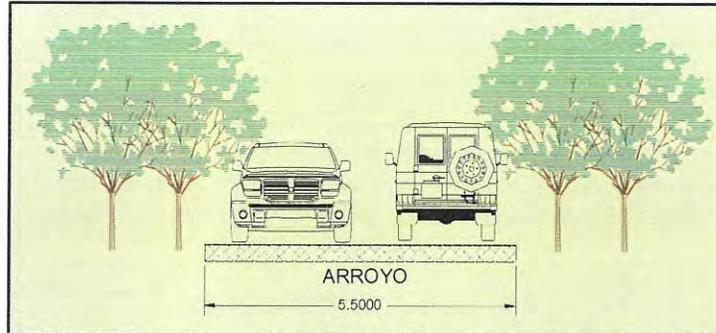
Sección transversal Acceso a Auditorio Nacional. Fuente: PROYECO.
